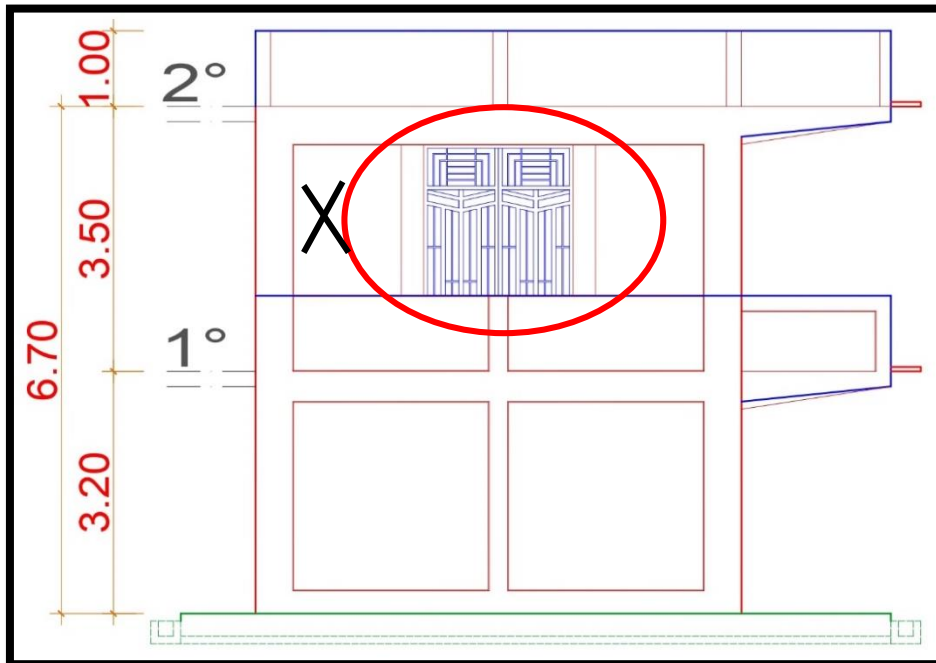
Plano de Elevación lateral derecha _MOD – 06: han colocado muros de albañilería, columnas y puertas a partir del 2° nivel (discontinuidad en los sistemas resistentes).
